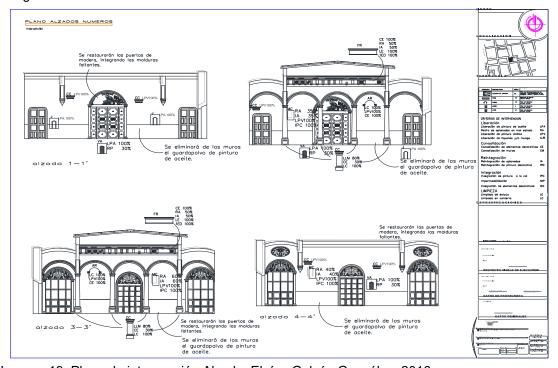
Plano de intervención Alzado. Eloísa Galván González. 2016
